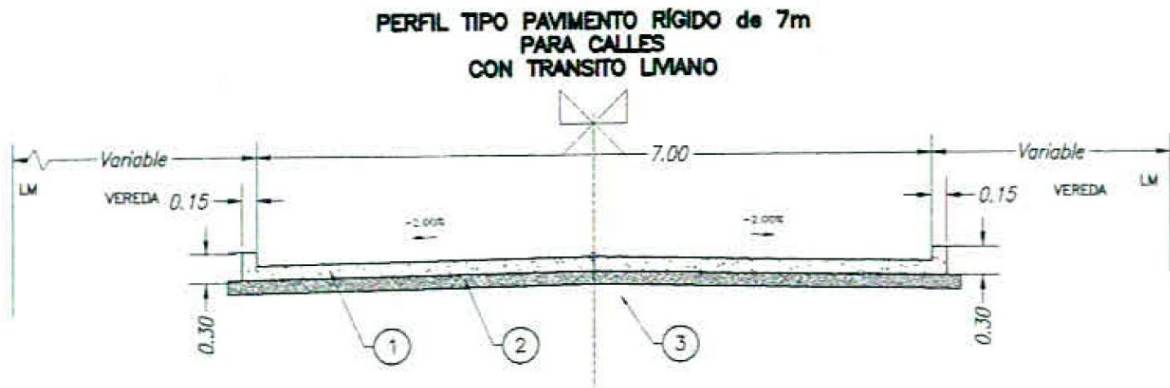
Perfil tipo Pavimento Rígido. – Fuente: Pliego técnico.
